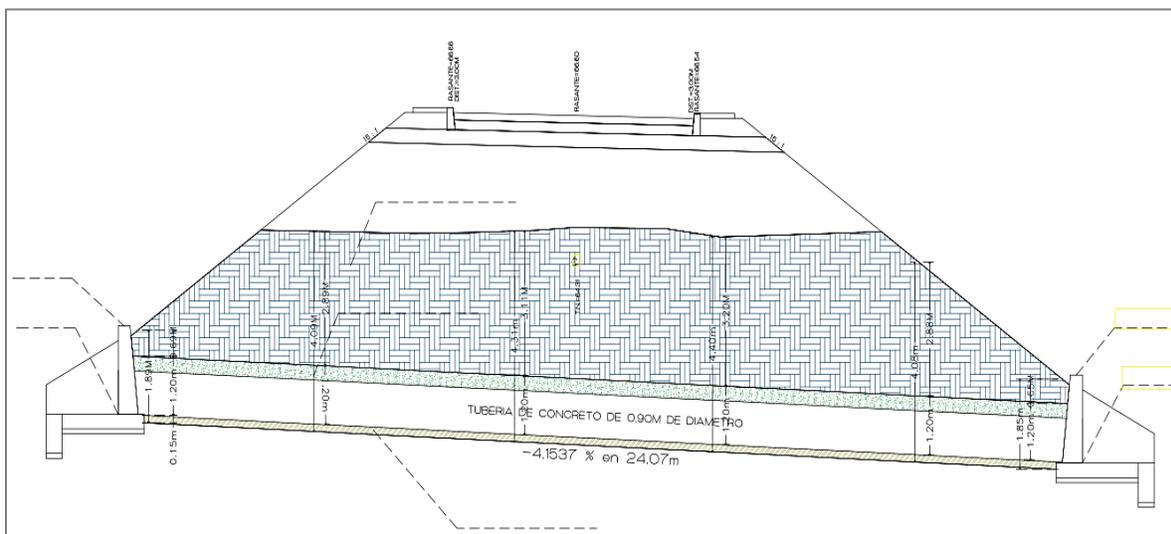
Detalle de los muros de cabeza de la obra de drenaje transversal
